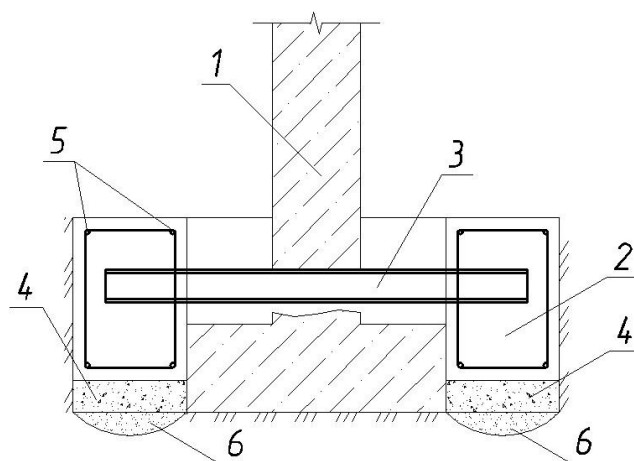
Збільшення ширини підшви стрічкового фундаменту улаштуванням приливів з бетону:
